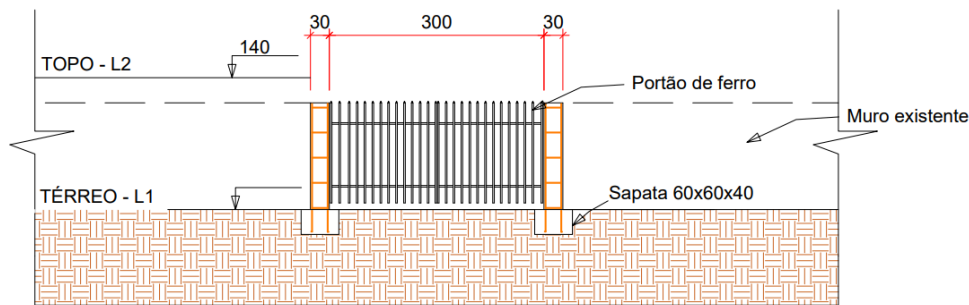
Vista frontal de muro com portão (Fonte: Autor/2024)
